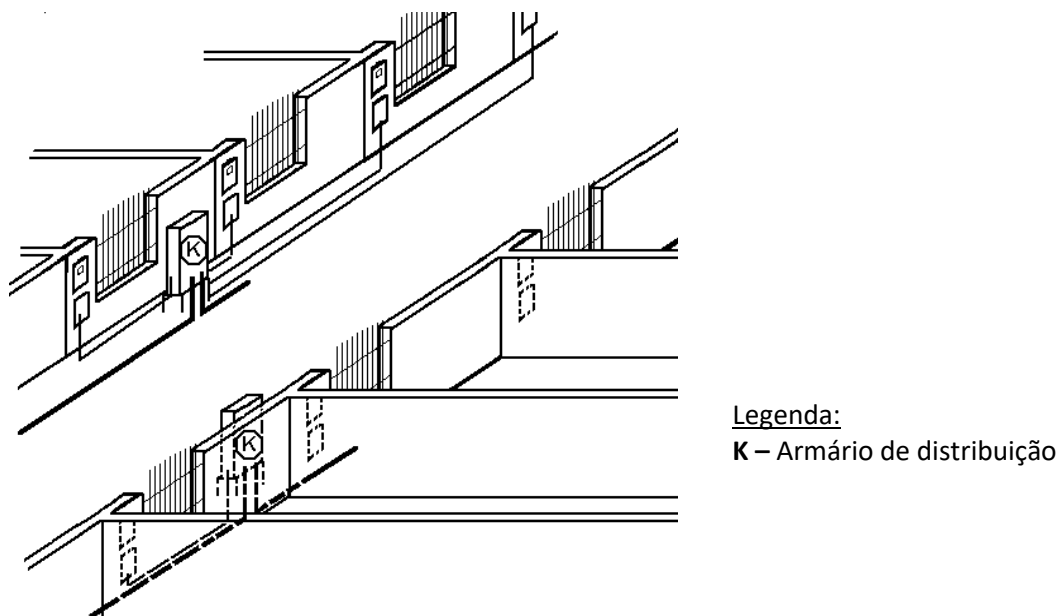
Ligação a partir de rede subterrânea – construções dotadas de muro
